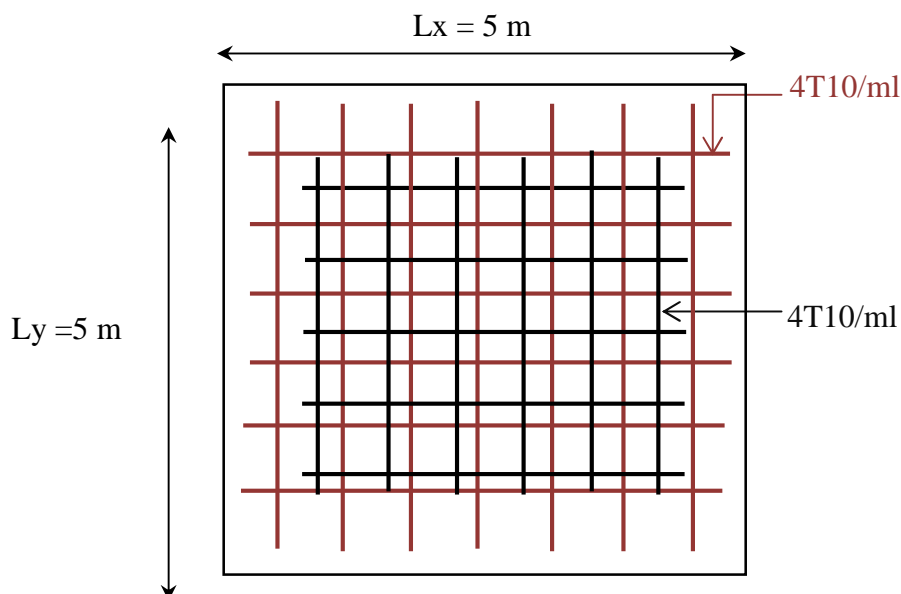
Dessin Ferrailage inférieur du panneau de la dalle pleine.
